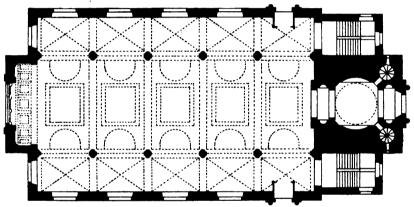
St. Brides church, Fleetstreet zu London. Grundriss.
